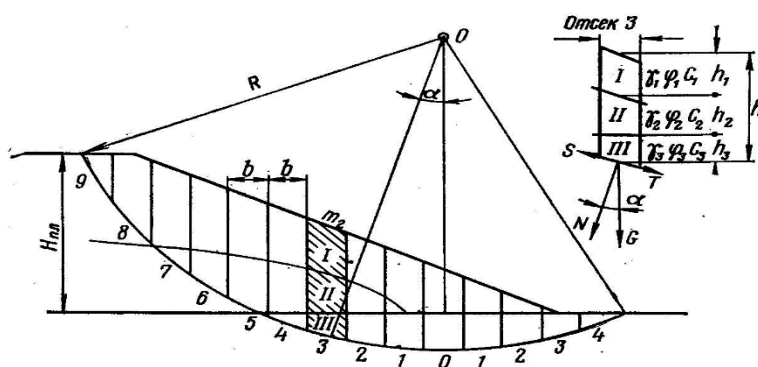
Схема к расчету устойчивости откоса методом круглоцилиндрических поверхностей скольжения: I – грунт тела плотины естественной влажности; II – грунт тела плотины, взвешенный в воде; III – грунт основания плотины, взвешенный в воде
